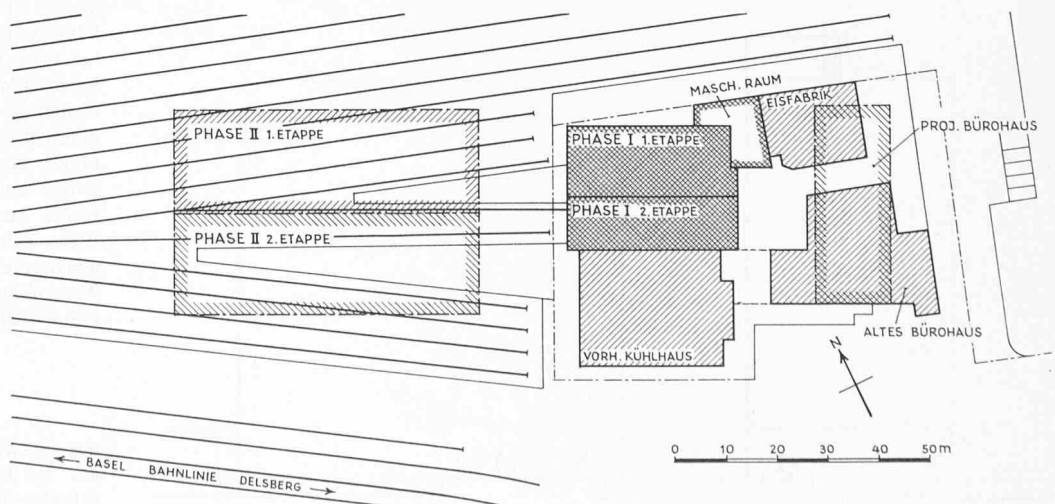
Lageplan 1:1500 der bestehenden Bauten, des neuen Kühlhauses und der projektierten Gebäude
